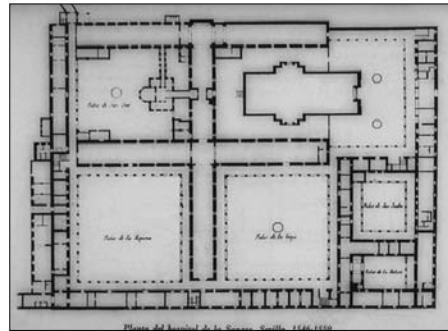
Planta del Hospital de la Sangre Sevilla, 1546-1559.
